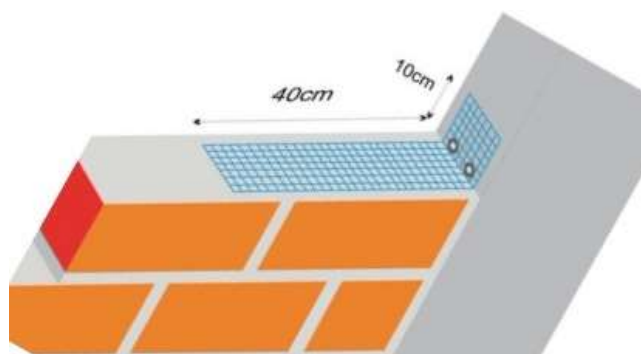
Detalhe de ligação estrutura/alvenaria com tela galvanizada
